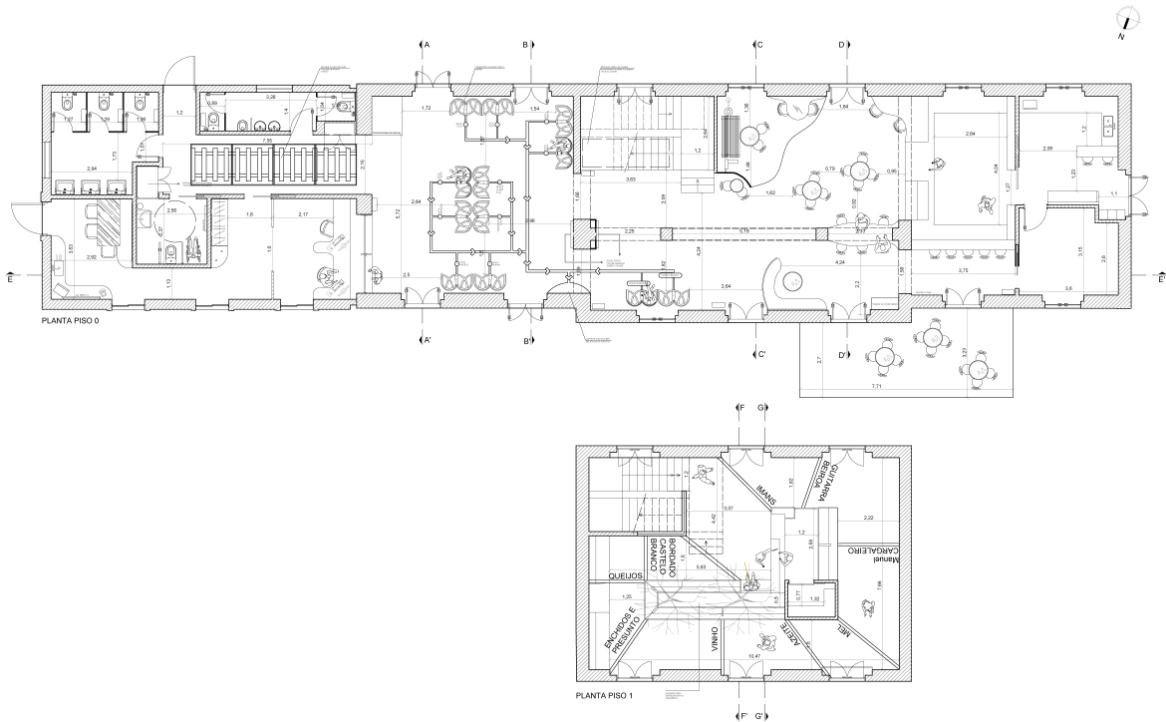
Planta de Apresentação cotada, Piso 0 e Piso 1
